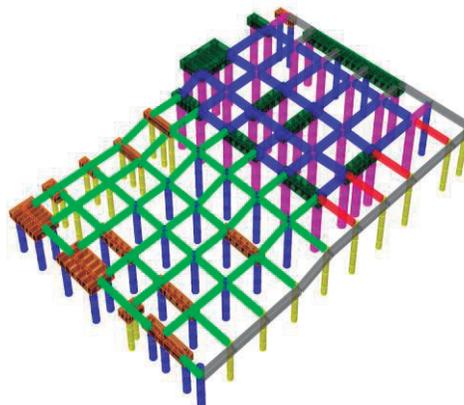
En gris se muestran las vigas de 1.3mx1.3m, en verde vigas de 1.0x1.30, en azul vigas de 1.5mx1.5m y en rojo vigas de 1.0mx1.40m
